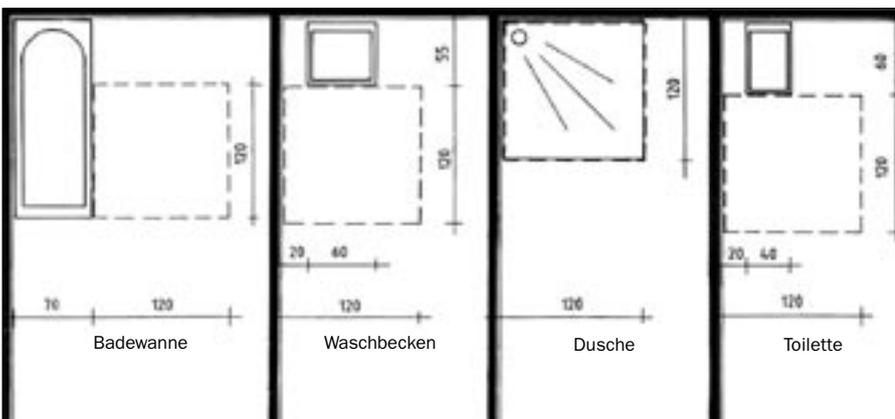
Bewegungsflächen nach DIN 18025 im Bad [27]
